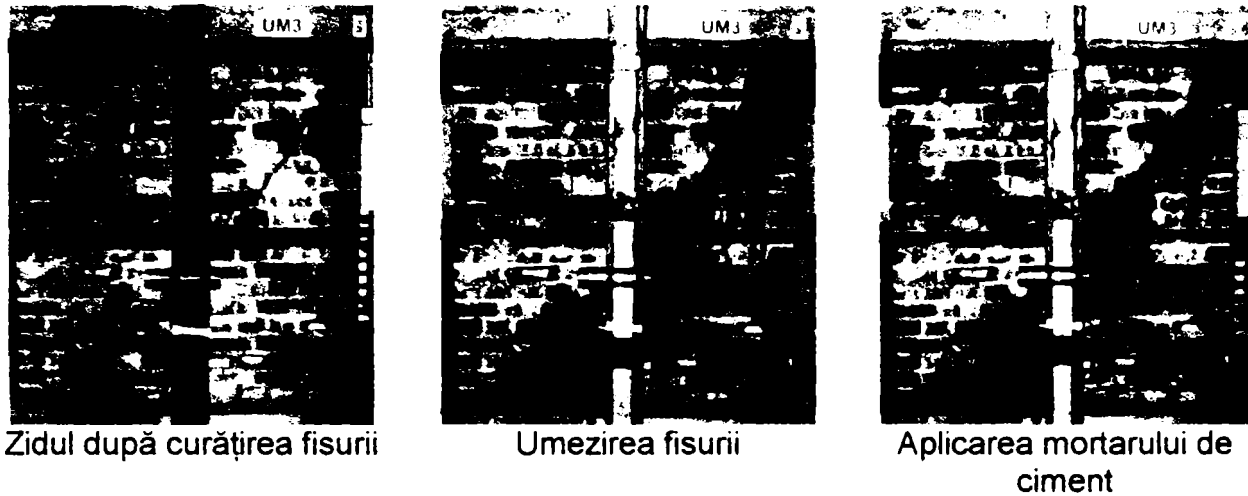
Umplerea fisurii cu lapte de ciment
